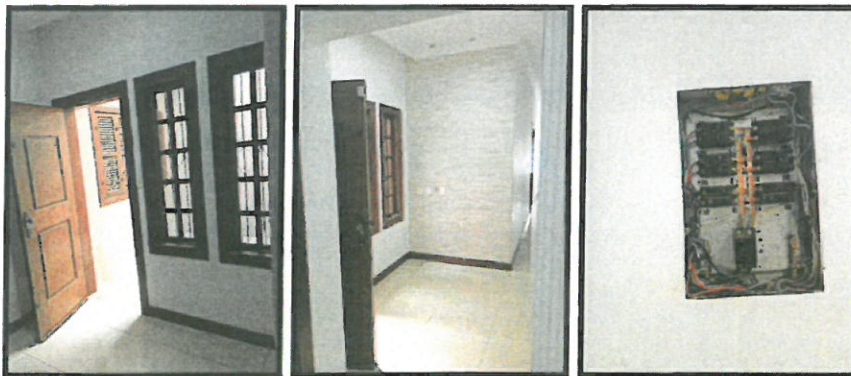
e 17: Hall de entrada. Observação ao quadro de distribuição.
